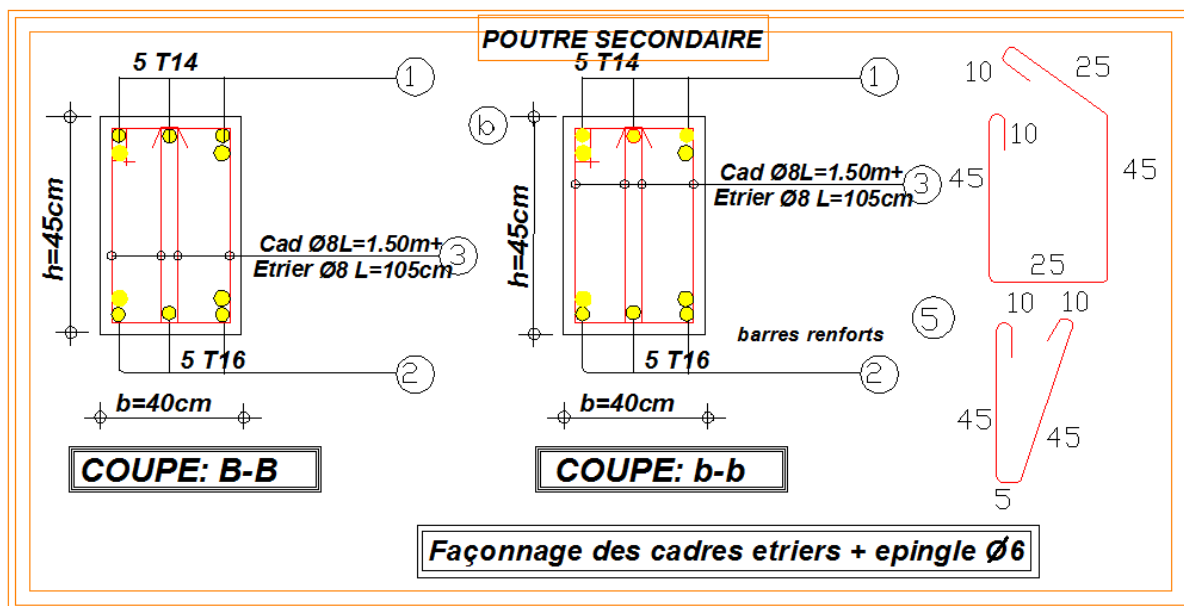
ferrailage des poutres secondaires de RDC7ème étage
